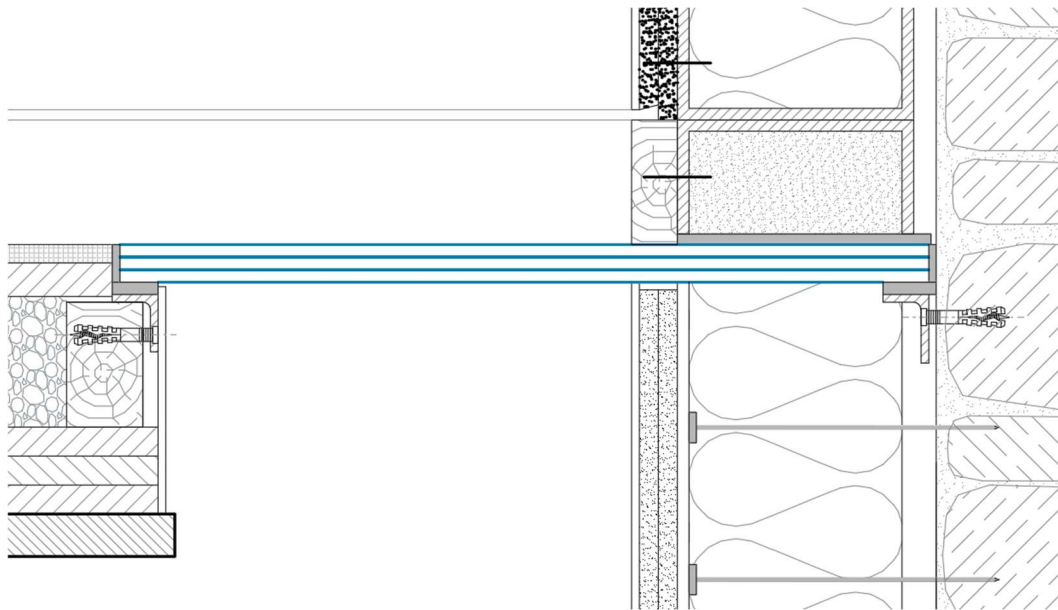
Aggancio pavimentazione in vetro, documento dell'autore
